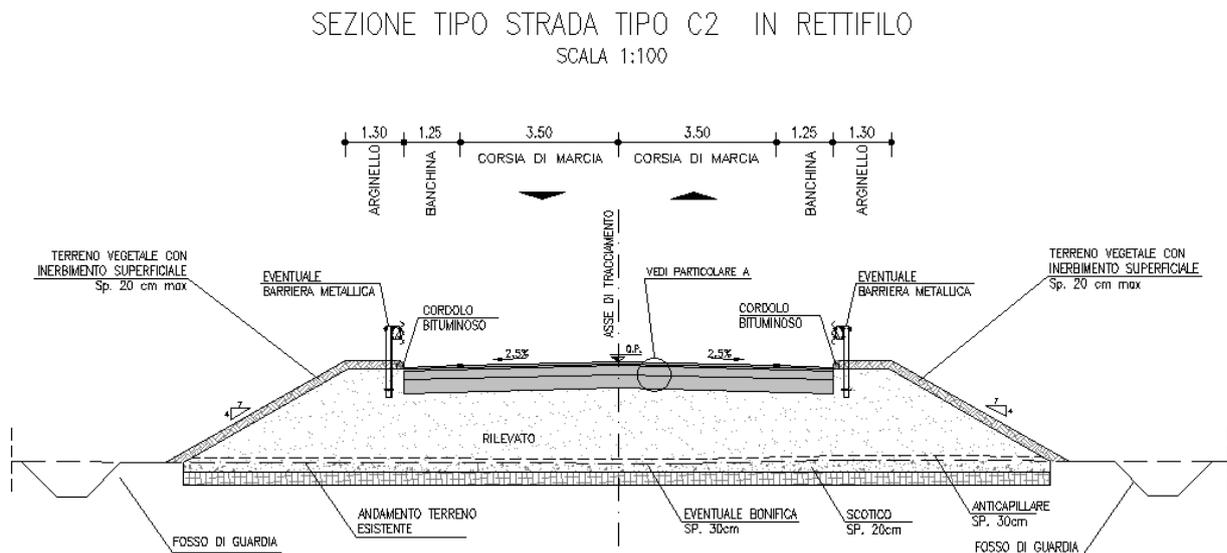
Sezione tipo di progetto assi SP204 nord e sud
